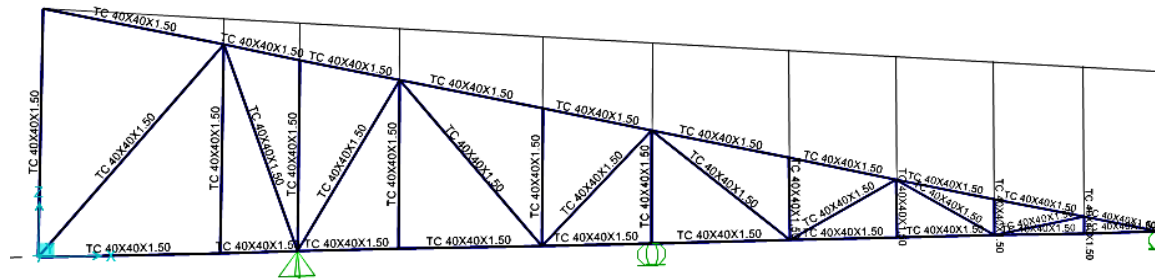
Modelo en SAP2000 de cercha tipo 1 para cubierta de la zona A. Fuente: Autor.
